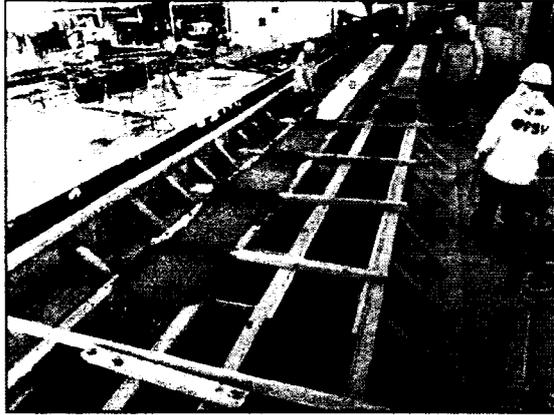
y 2. Armadura y encofrado de pilote adicional eje 33.
